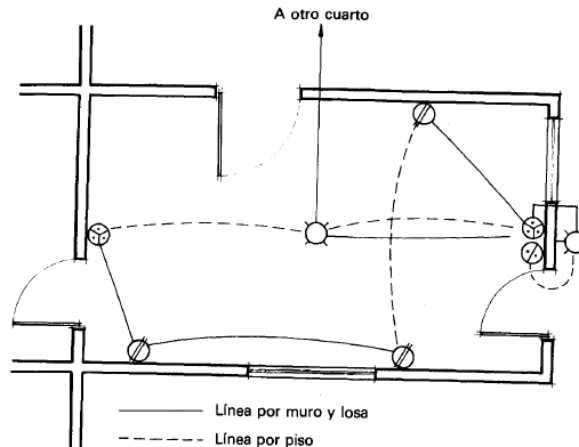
Plano simplificado de un cuarto de casa mostrando las posibles trayectorias del tubo conduit.
